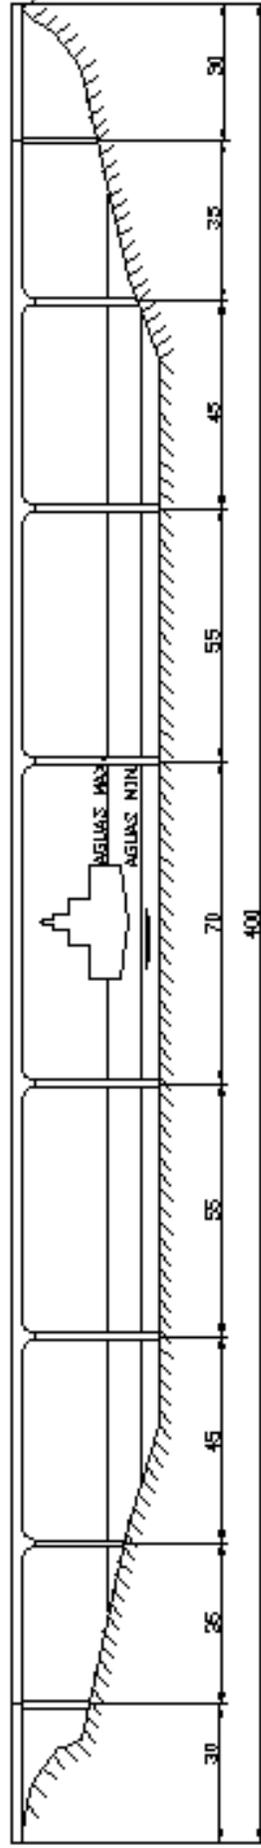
Opción n°3: Puente Gerber. Sección Transversal.
